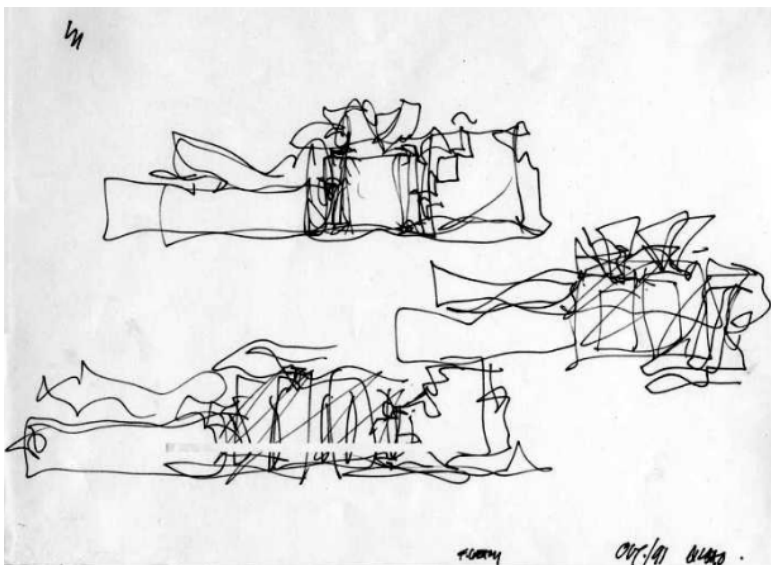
Frank Gehry, croquis preliminares de fachada – Guggenheim, Bilbao
